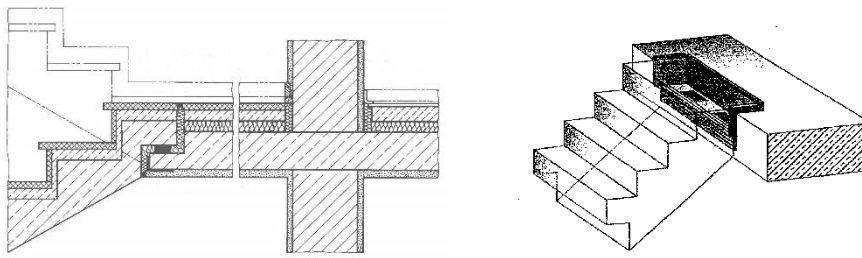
Tonsole aus Produktunterlagen Fa. Schöck Bauteile GmbH
